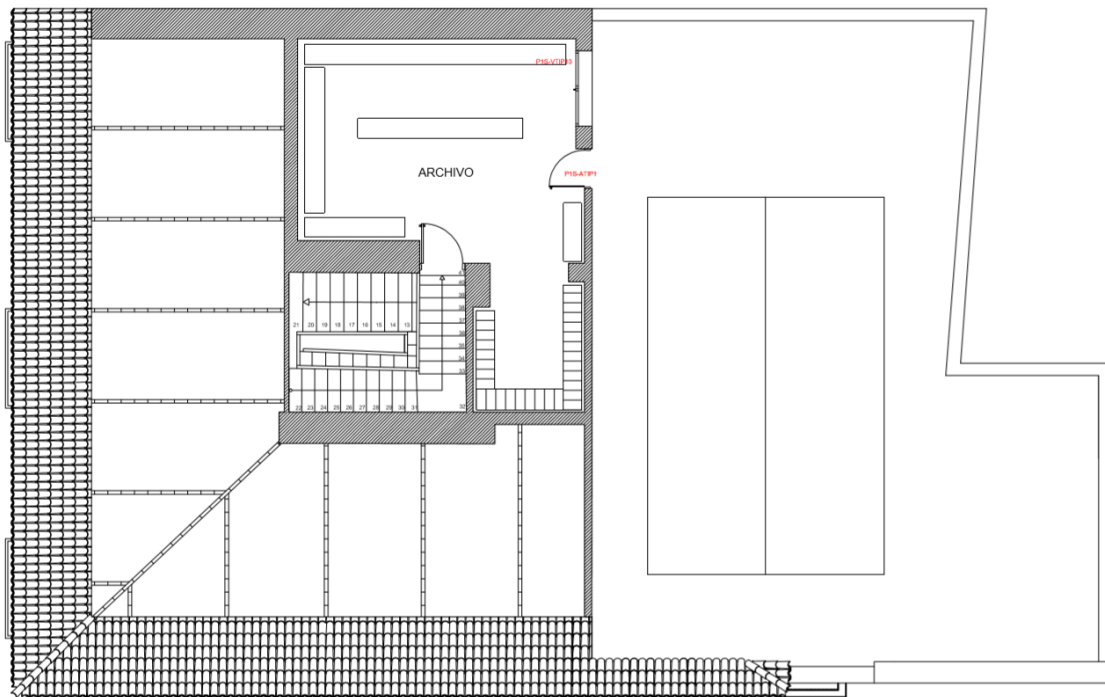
Plano planta segunda, estado actual. Fuente: Elaboración propia, creación 24/01/2019
